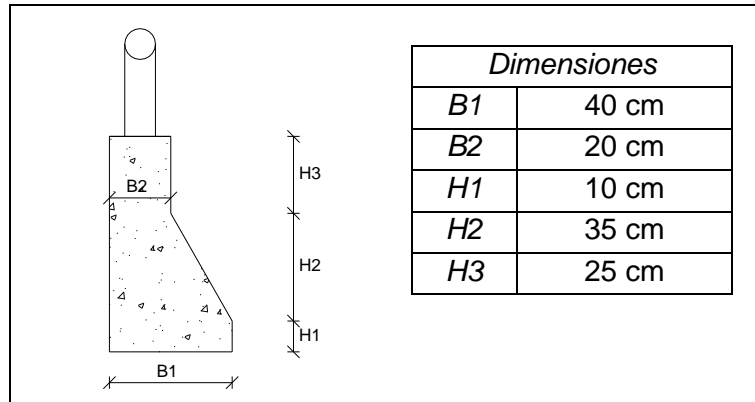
Croquis y dimensiones de la guarnición y del parapeto.
